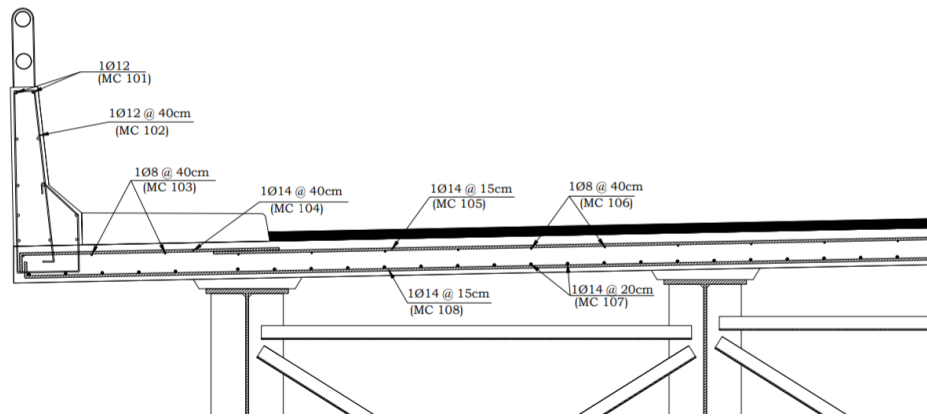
Detallamiento de acero de refuerzo en el tablero. Fuente: Elaboración propia
